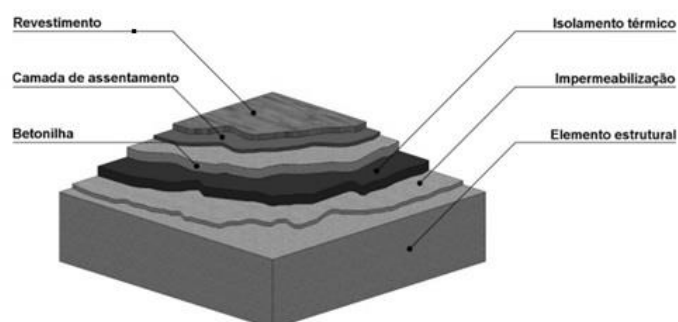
Camadas genéricas constituintes de um pavimento [17].
